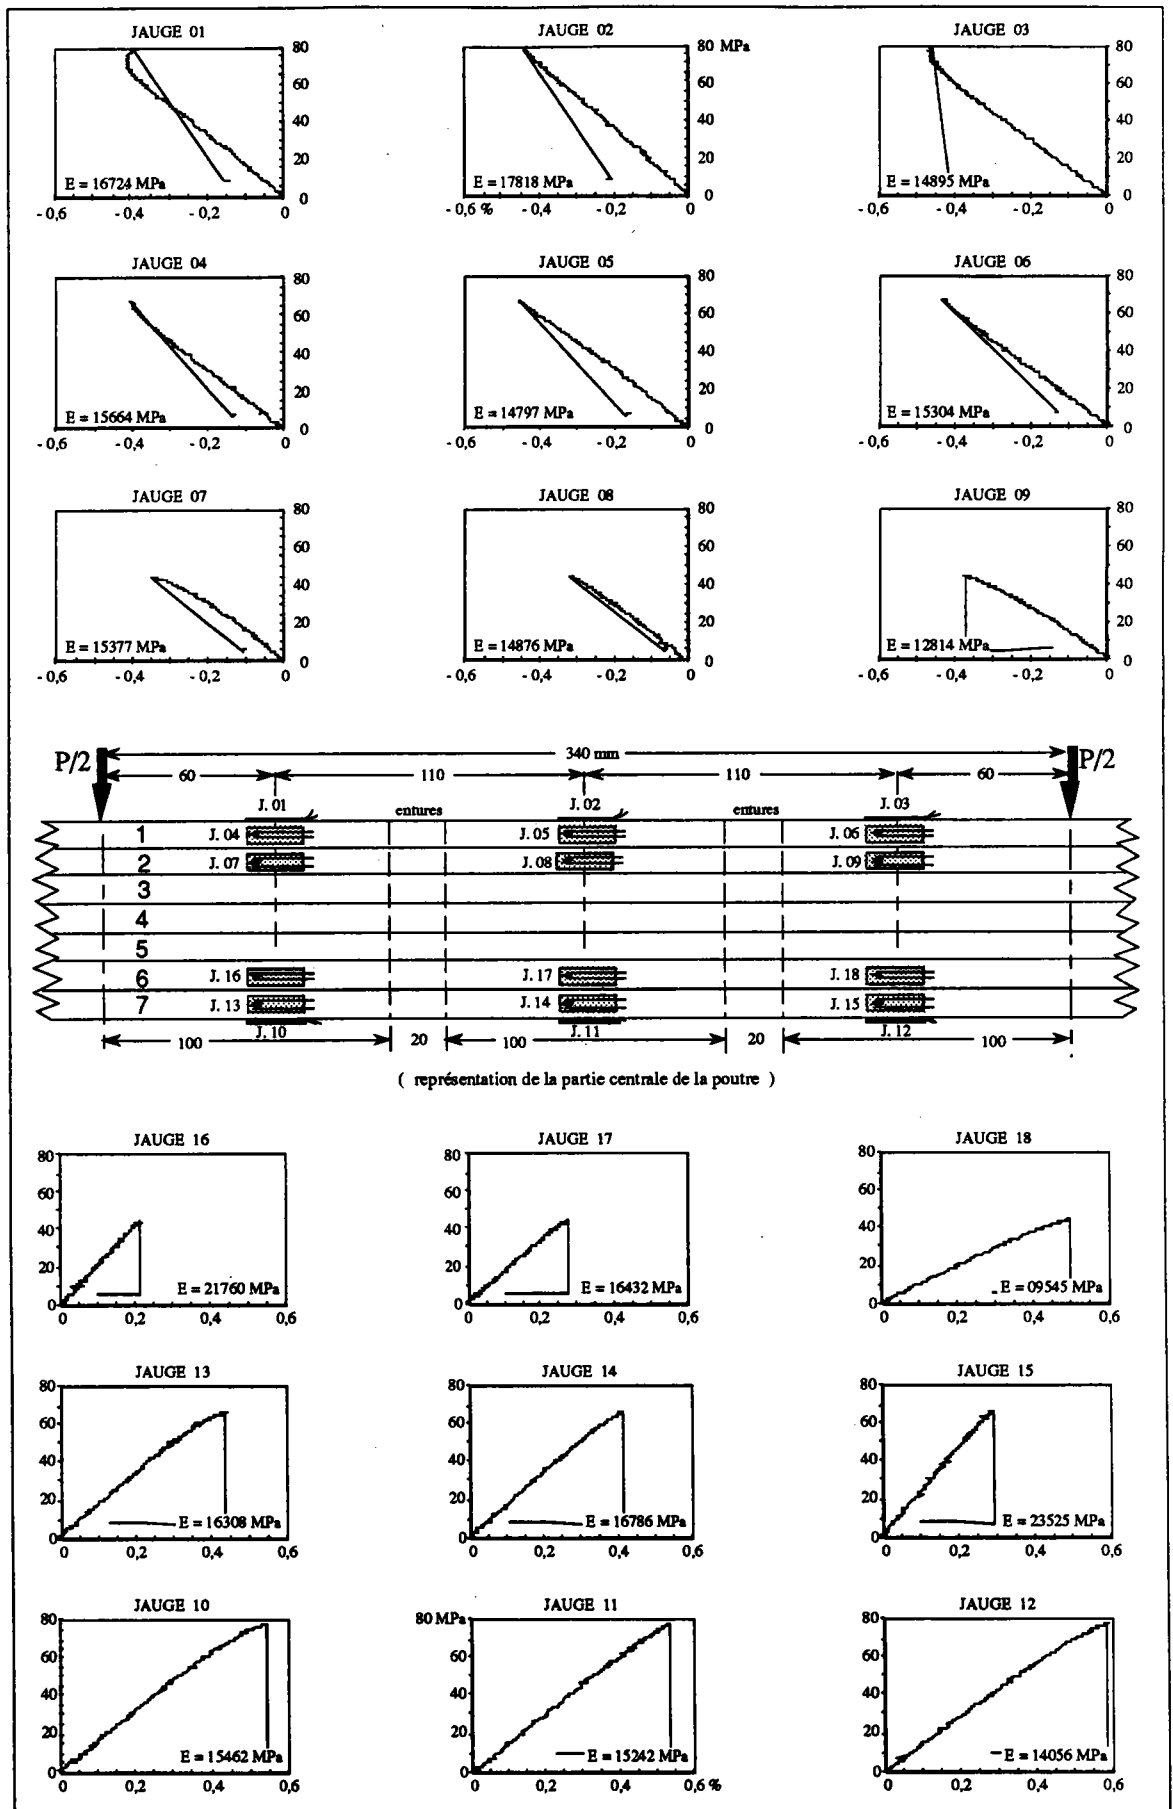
Comportement de la déformation sur plusieurs points de la poutre n° 04.
